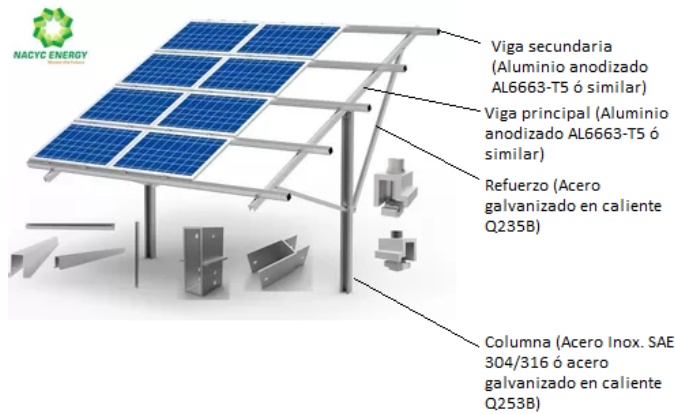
Estructura de montaje PV de columna única. Adaptado de Nacyc Energy.
